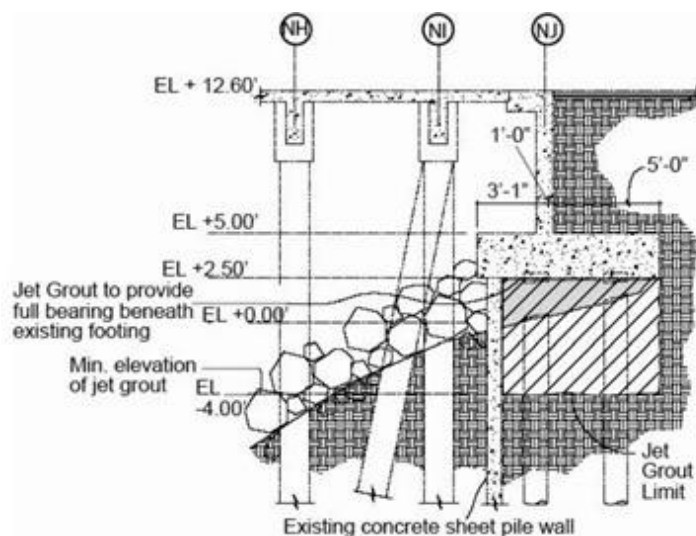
Поперечное сечение основания железобетонной подпорной стены после устройства грунтоцементных колонн [14]
